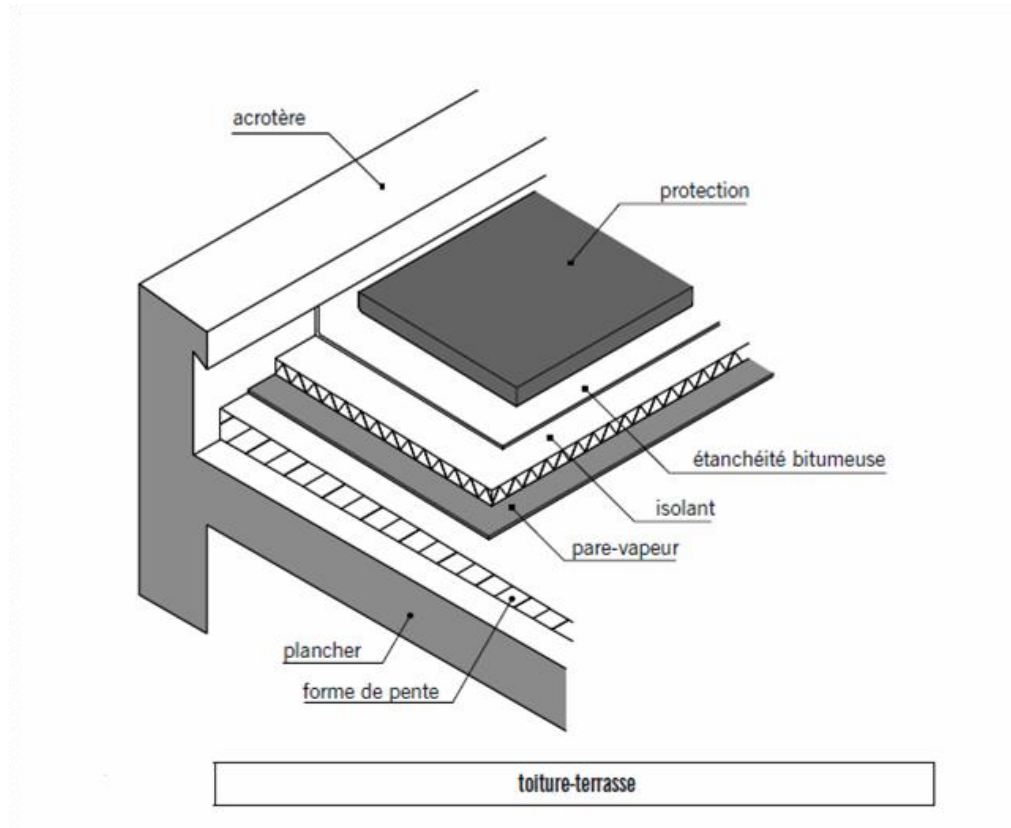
Coupe transversale d'un plancher terrasse inaccessible.
